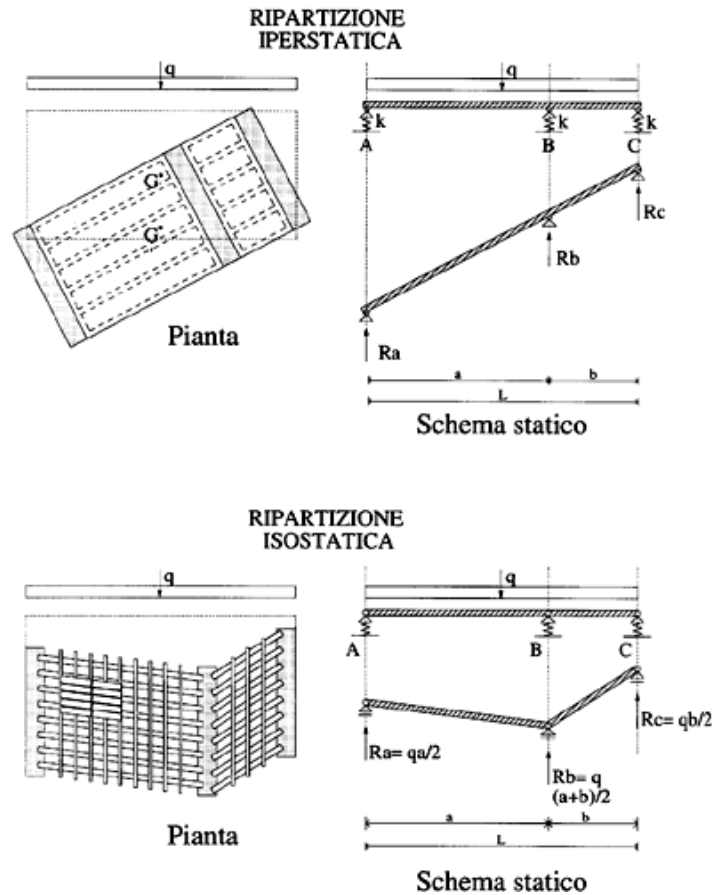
Ripartizione iperstatica (a piano rigido) e ripartizione isostatica.
